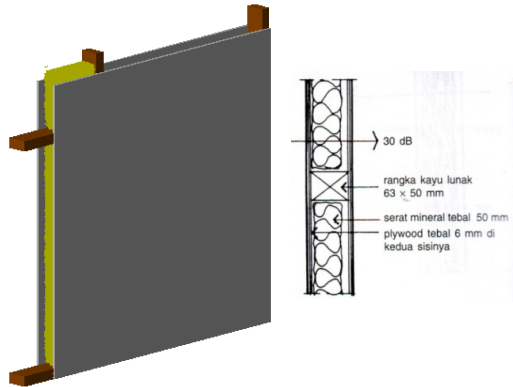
Denah, Potongan, Detail Dinding STC 35 dB
